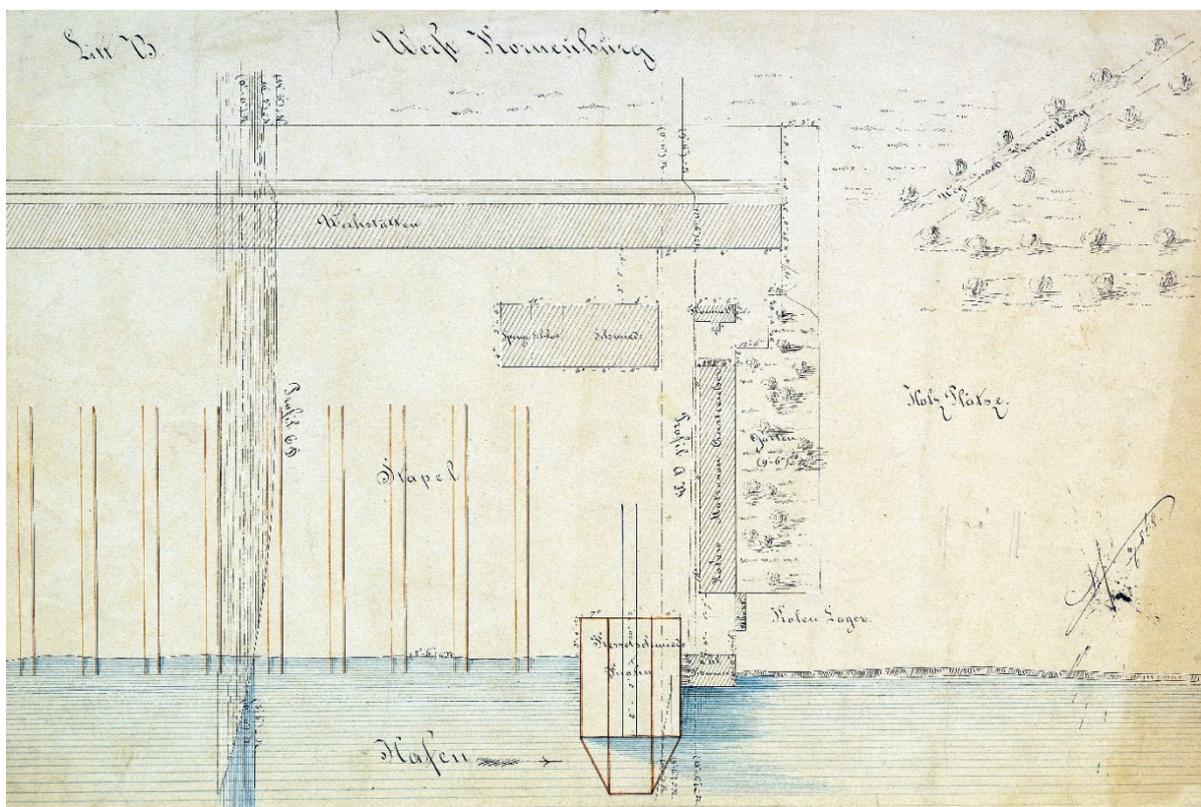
Grundriss Schiffswerft Korneuburg, gezeichnet um 1868 (ältester im Stadtmuseum Korneuburg erhaltener Plan des Werftgeländes).
